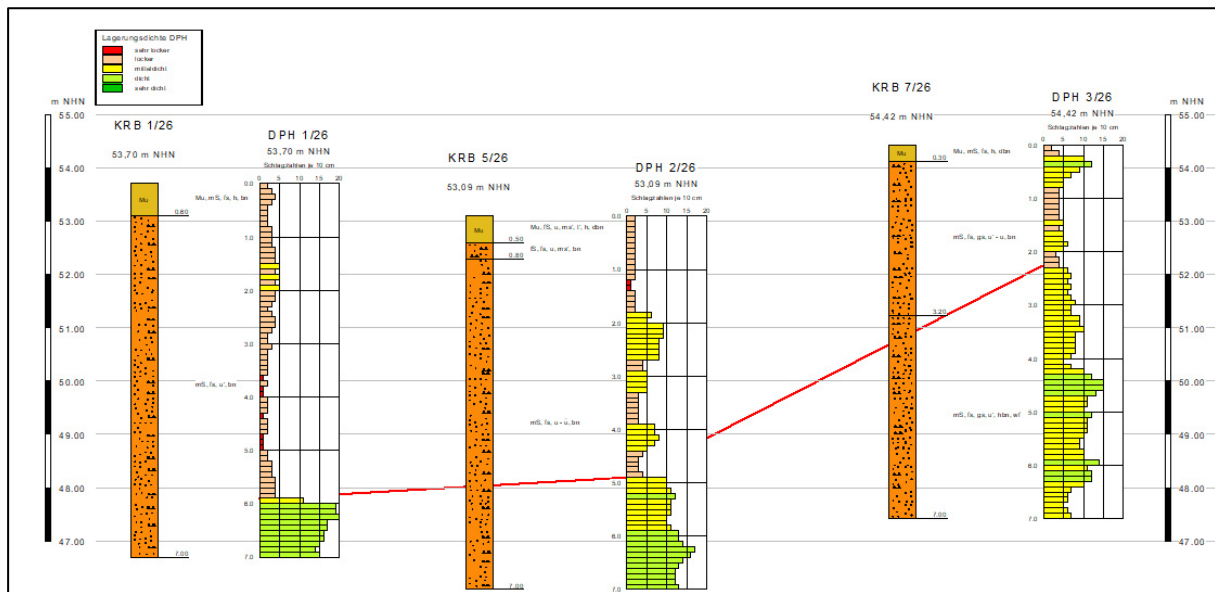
Baugrundprofil – Horizontunterkante lockerer Lagerungen (rot)
